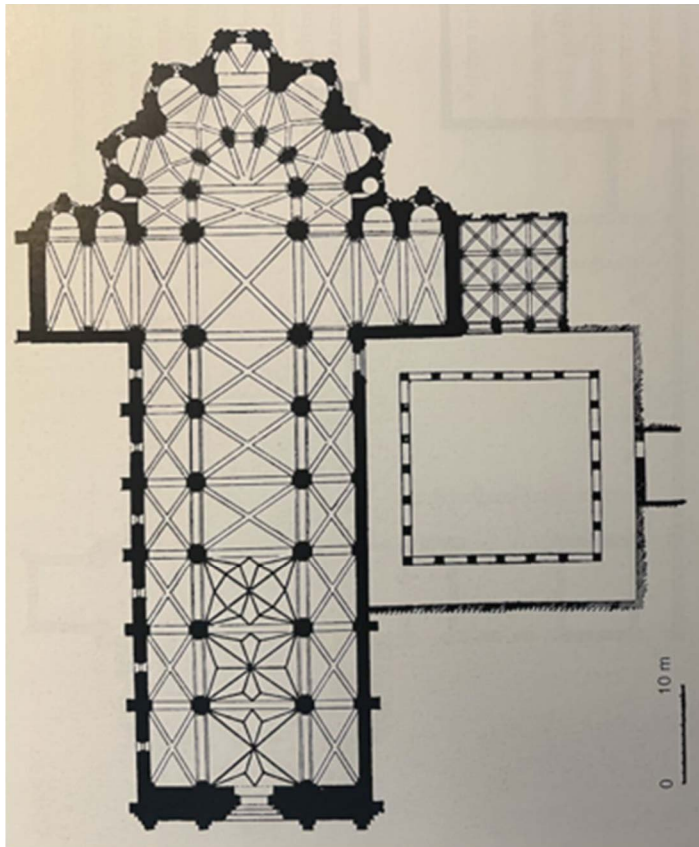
Fitero, Santa María, Grundriss der mittelalterlichen Bauteile, V. Lampérez, 1906.
